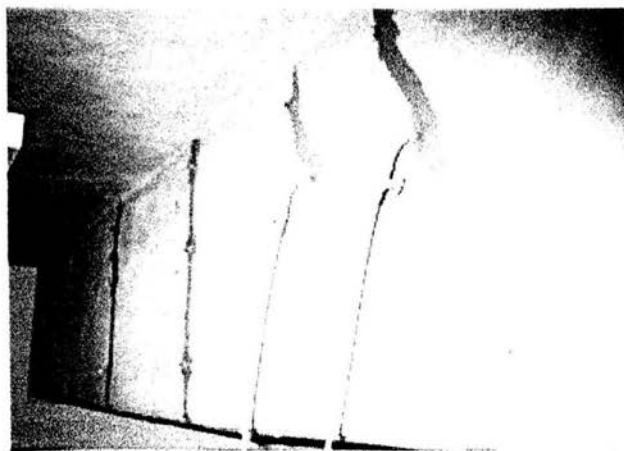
Reparación de grietas en muros mediante la inyección de morteros de cemento.
